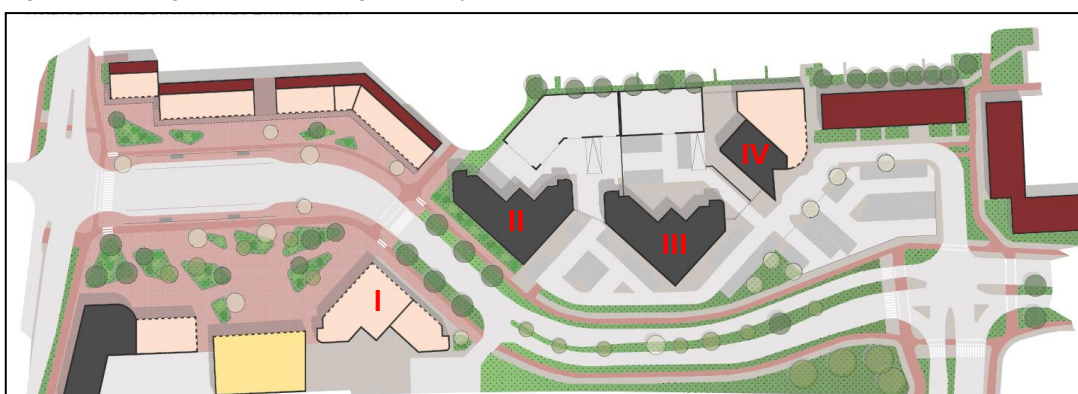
Overzicht bebouwing noordzijde Stationsweg: zicht vanuit westelijke richting.
